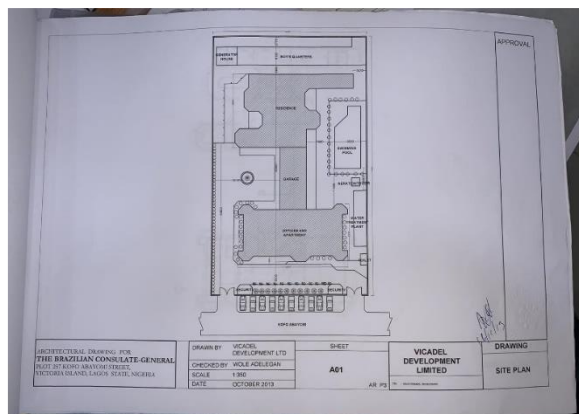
Planta de implantação do projeto. Fonte: Cedido pelo Consulado-Geral em Lagos.
